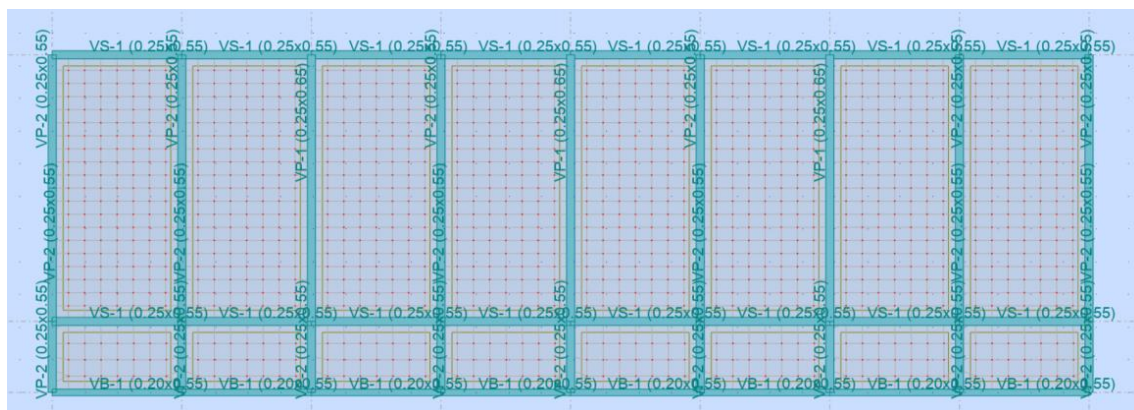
Elementos estructurales del primer piso del Bloque B.
